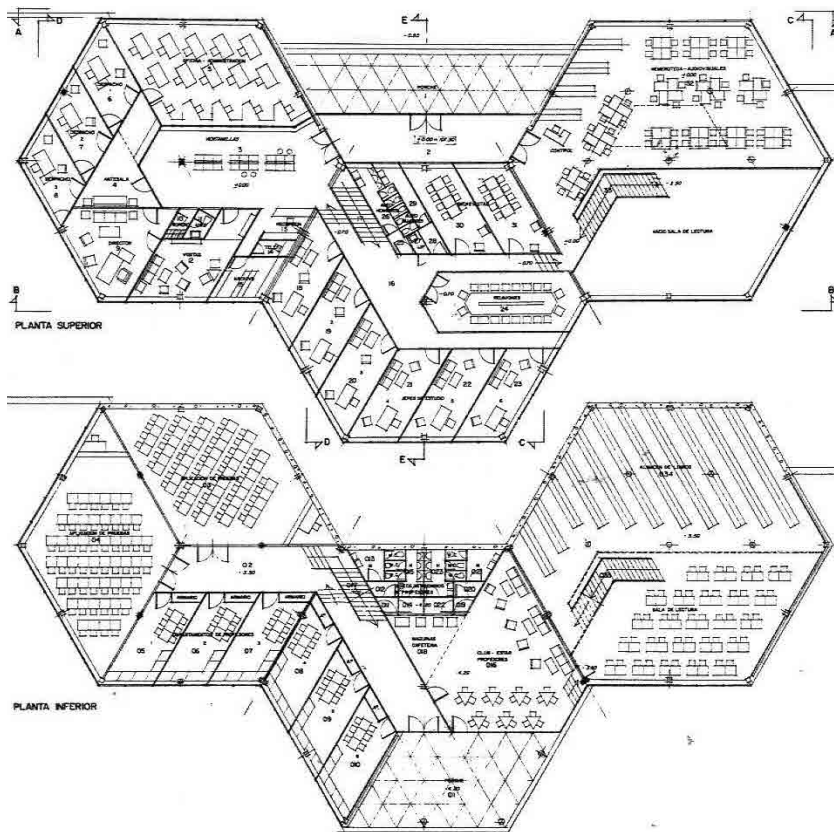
y Fig. 25 Edificio de dirección. Planta superior (arriba) y planta inferior (abajo).
